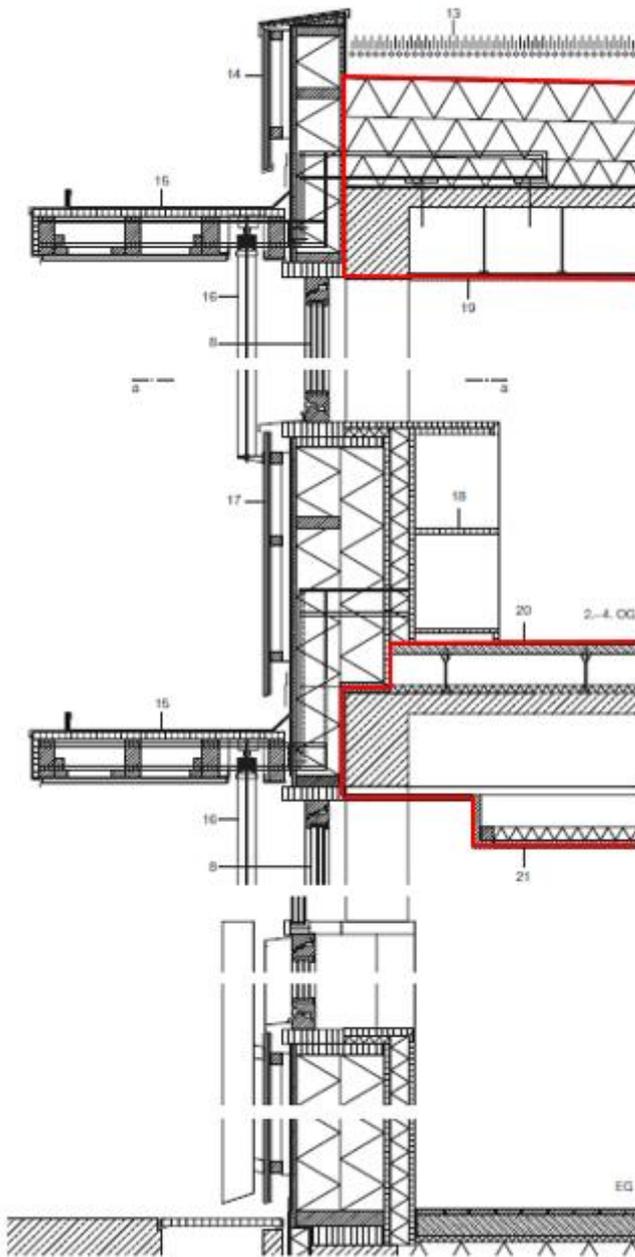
Fassadenschnitte hier Illwerke Zentrum Montafon (Quelle Detail Verlag)
